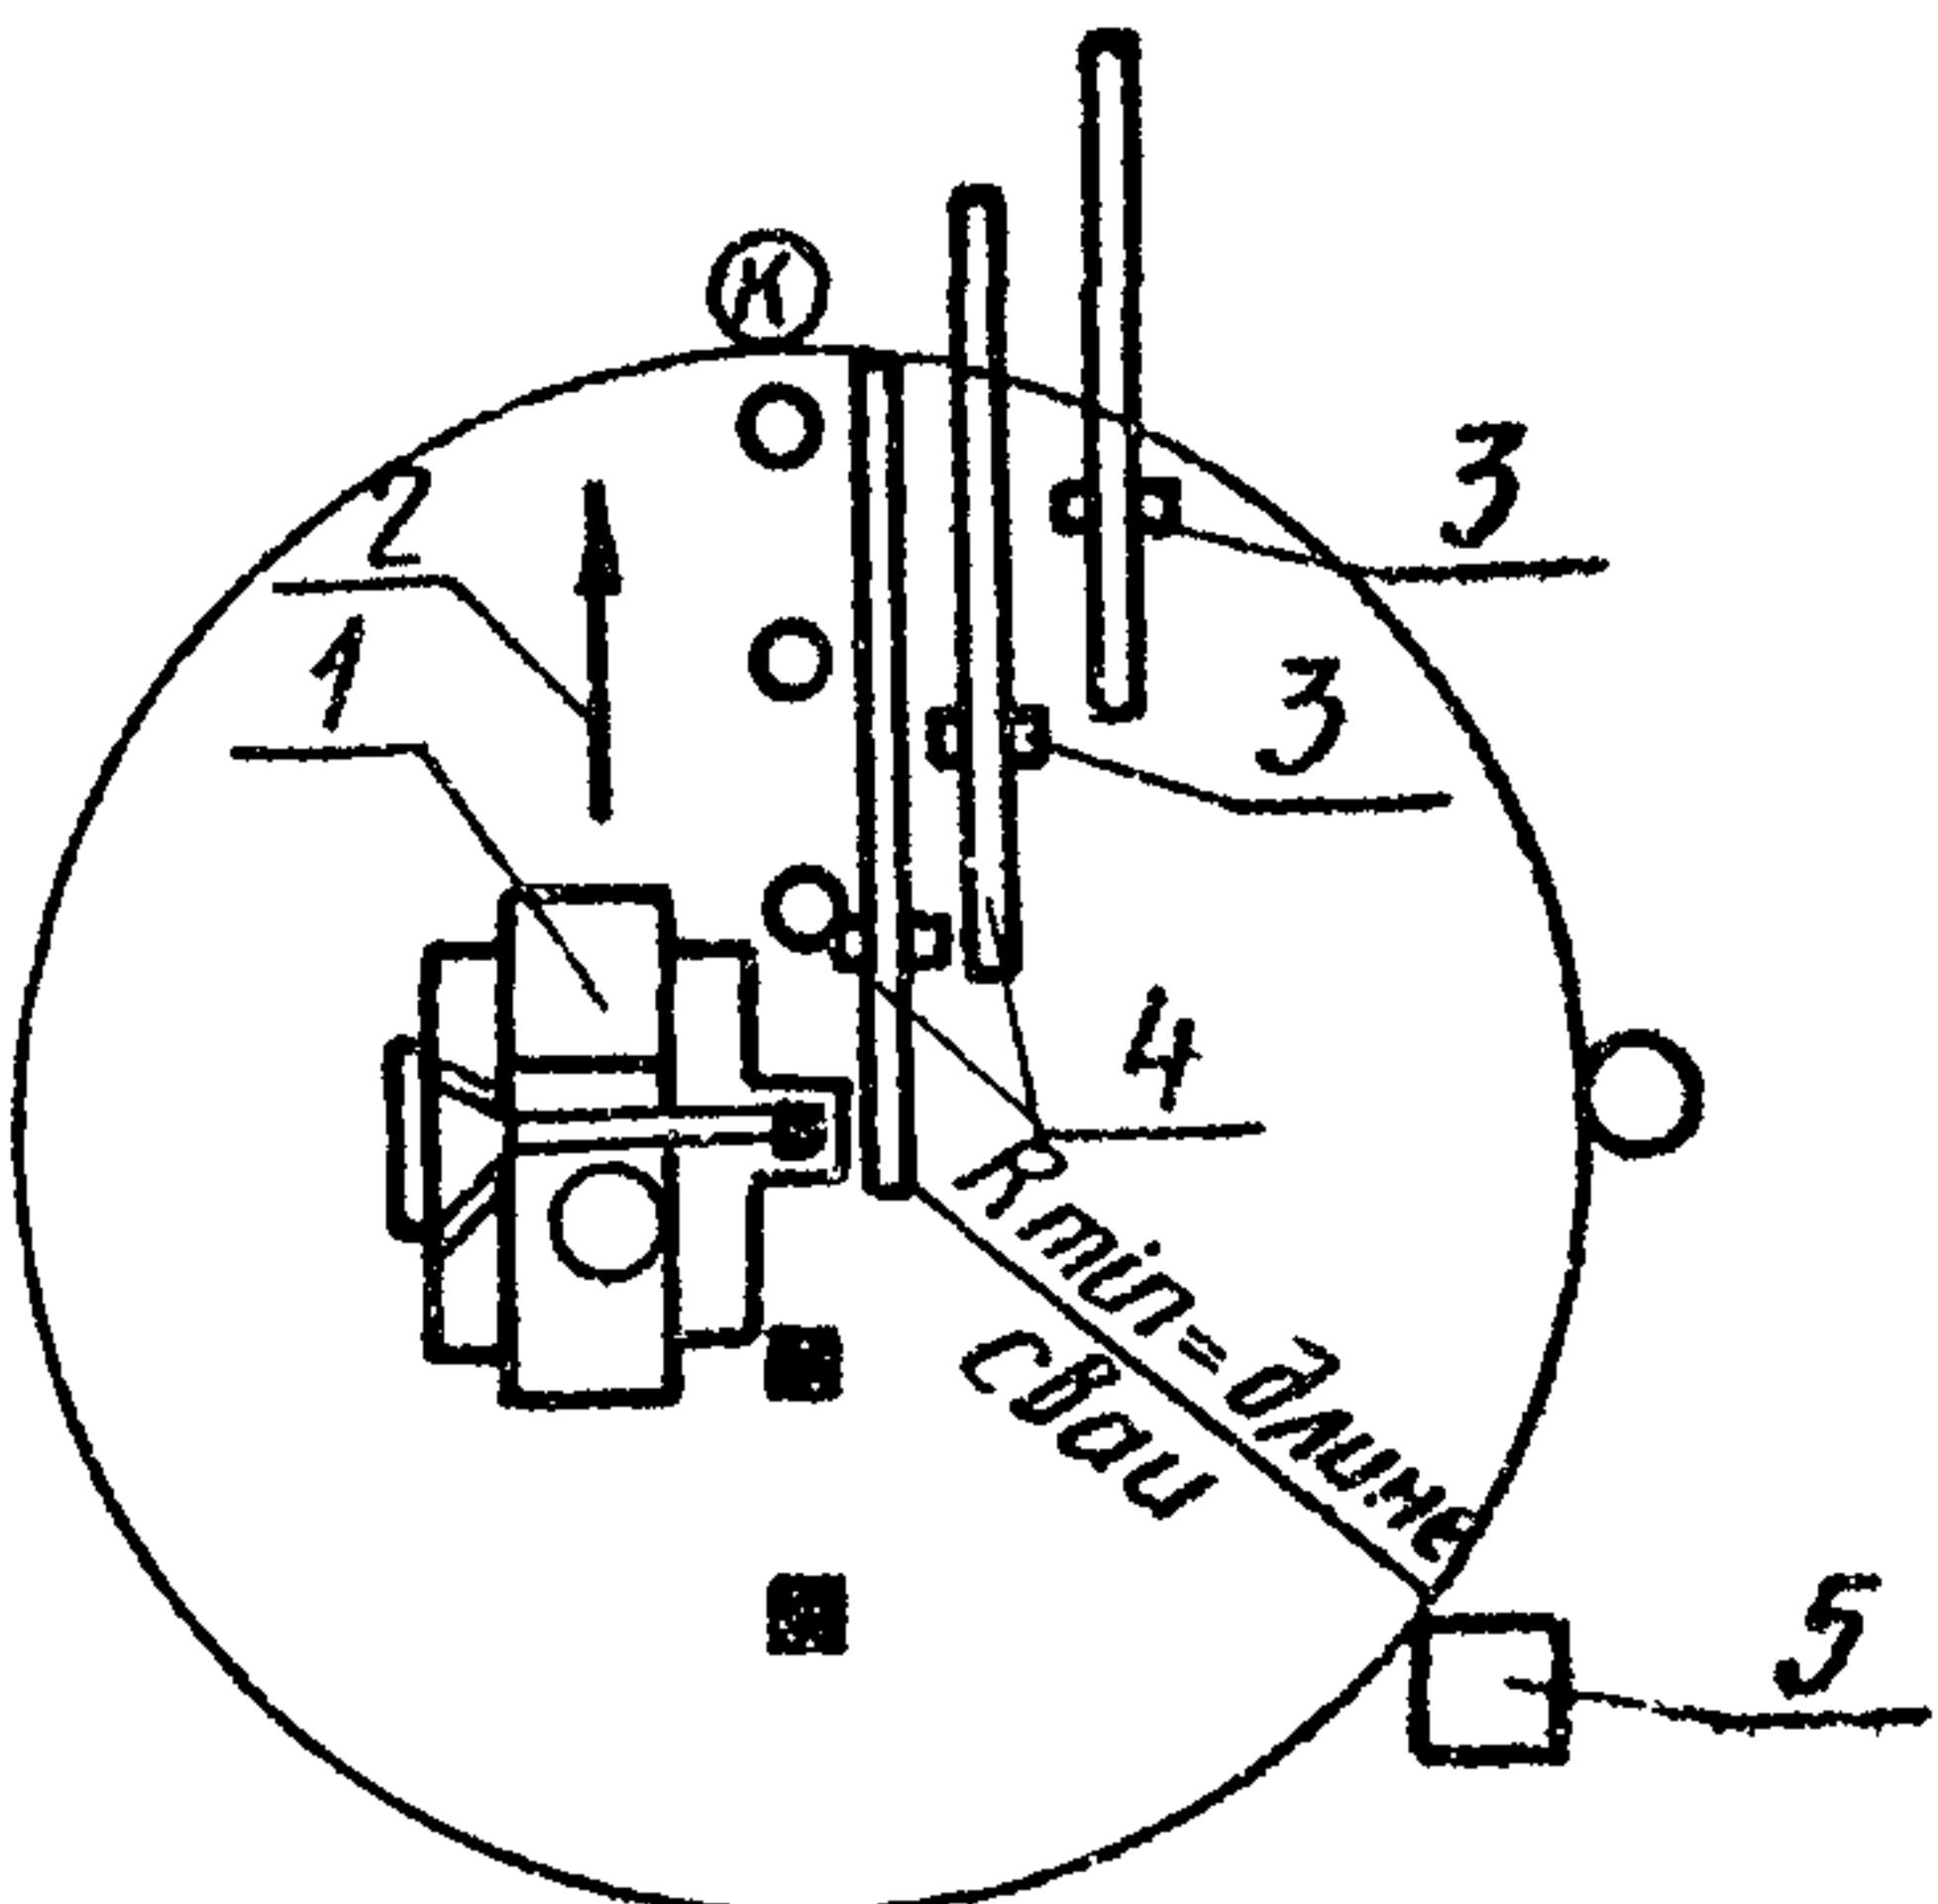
Схема организации рабочего места: 1-агрегат С-878М; 2-направление движения агрегата; 3-сваи; 4-деревянные прокладки; 5-место складирования инструмента и приспособлений, \textcircled{K} - местоположение членов экипажа в процессе погружения свай
